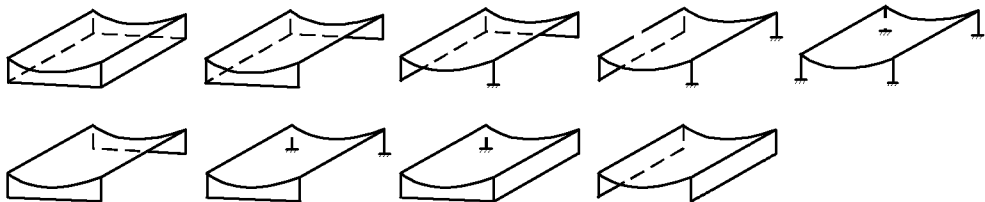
Модели для аэродинамических испытаний сооружений с цилиндрическими покрытиями на квадратном плане и различными вариантами расположения стенового ограждения
